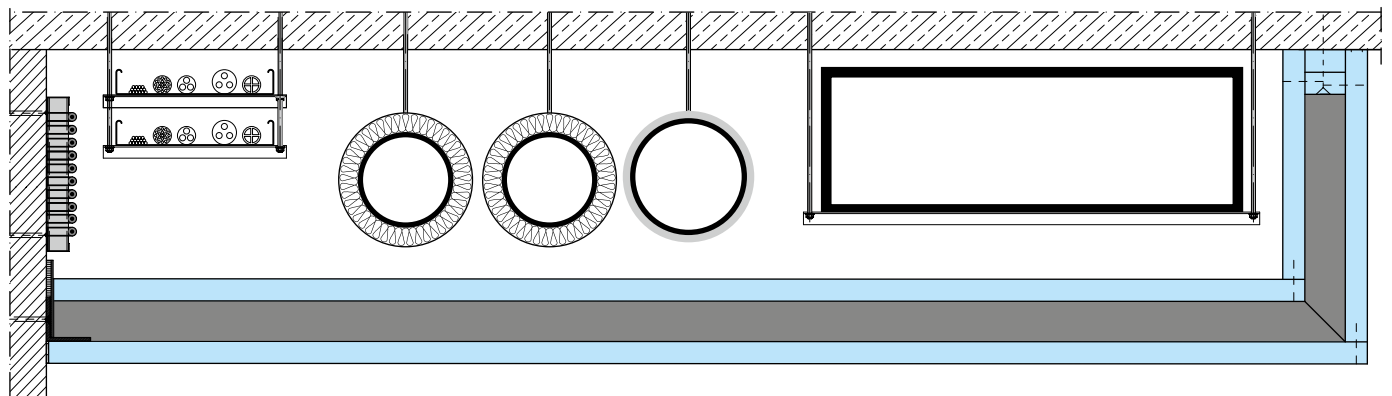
zweiseitige Ausführungsvariante unterhalb von haustechnischen Installationen
